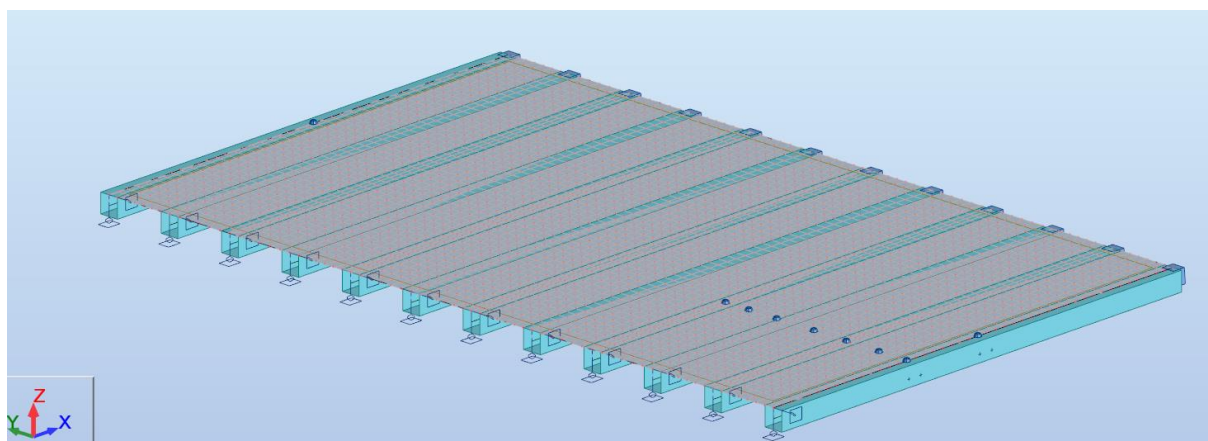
simulação numérica do pavimento PVRR_8
